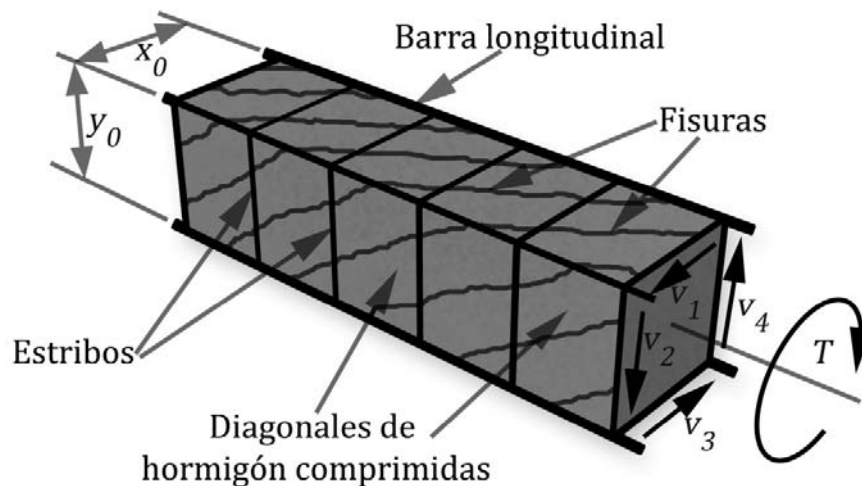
,4: Torsión en tubos de paredes delgadas de Hormigón Armado
